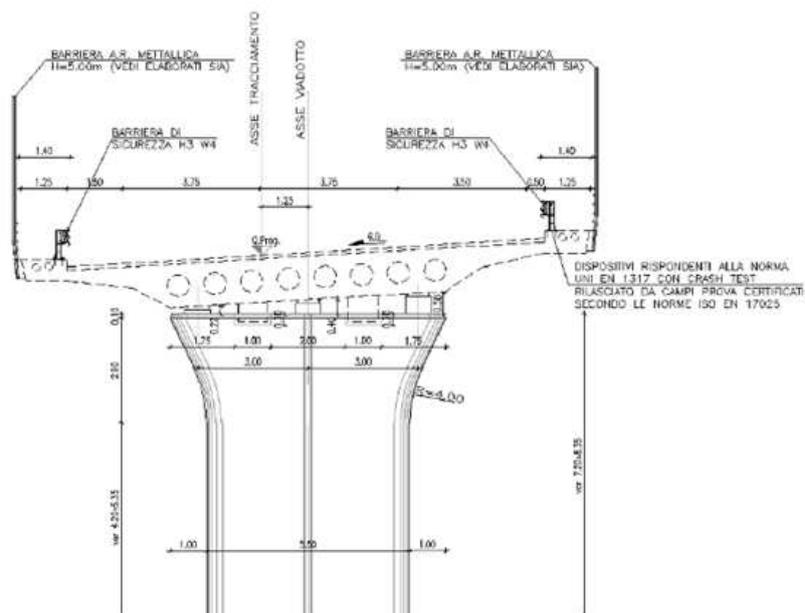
Viadotto S.Venerio I – Sezione Trasversale
